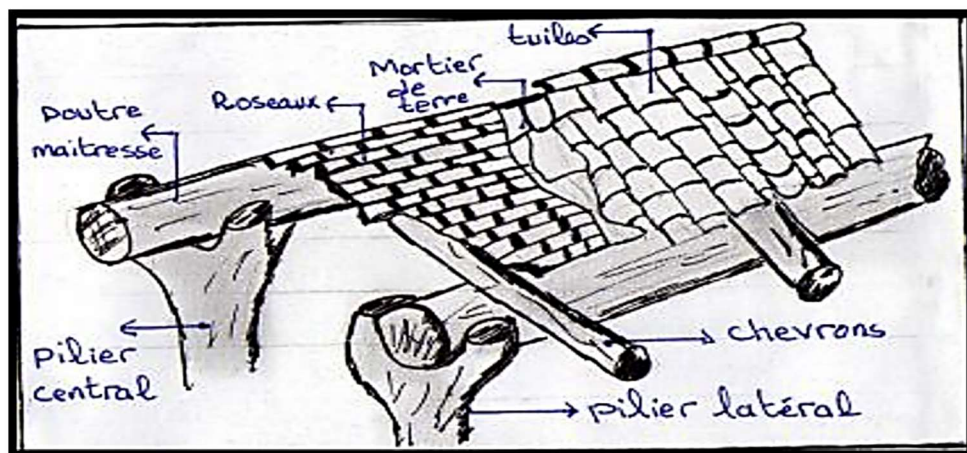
Détails de la toiture en tuile de la maison kabyle.
